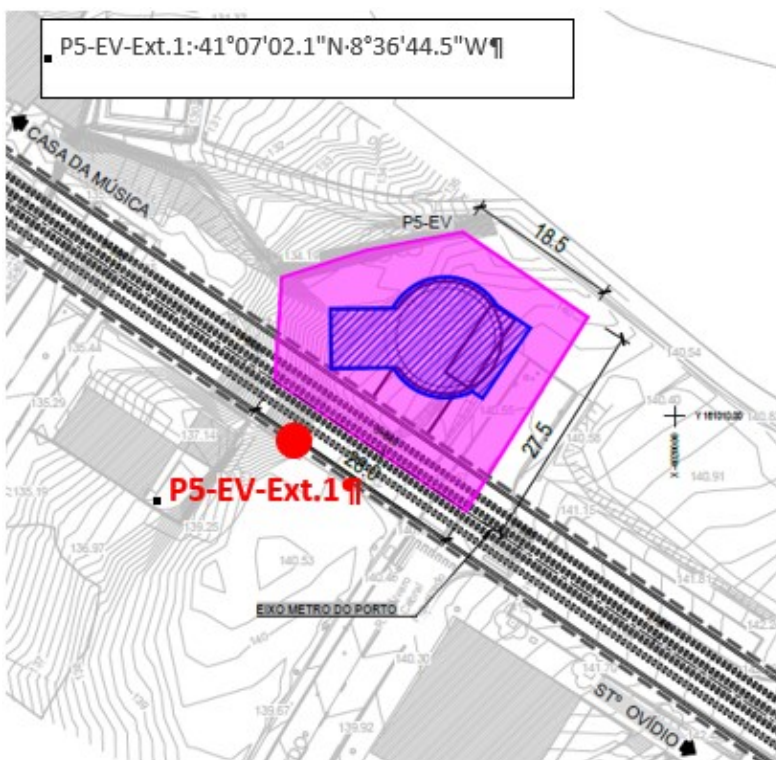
Pontos de monitorização junto a P5-EV (vibrações – construção)
